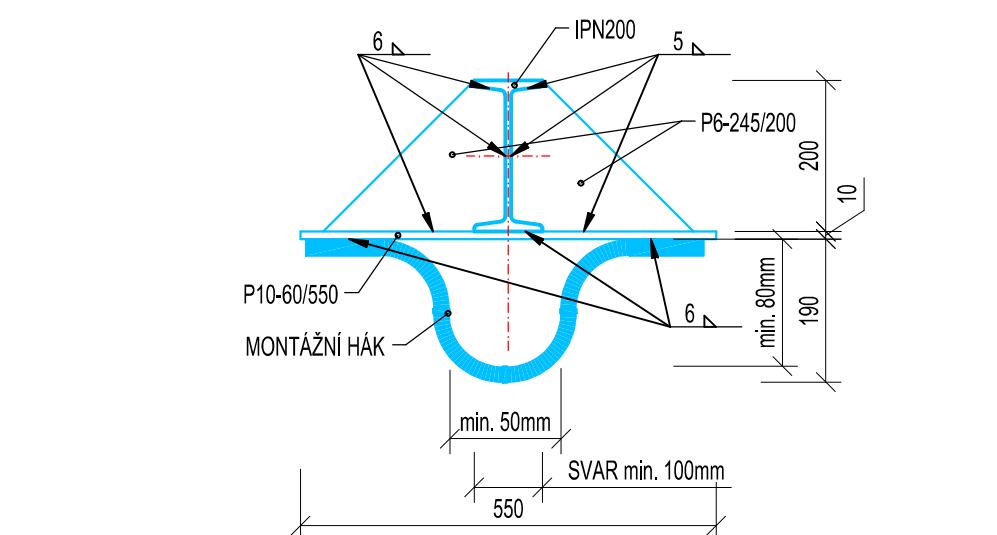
DETAIL KOTVENÍ KOTEVNÍHO PRVKU VODÍTEK DO ZDIVA - ŘEZ, M 1:10
